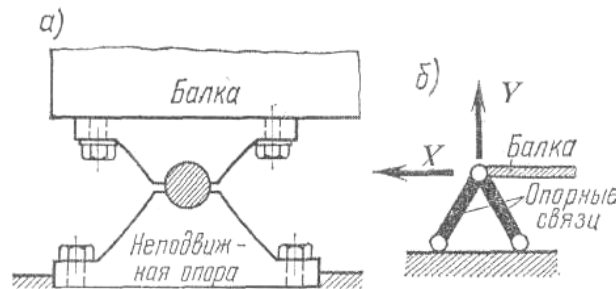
Шарнирно-неподвижная опора: *а* – вид опоры;
